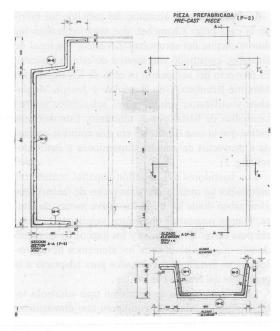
Detalle de los paneles de hormigón visto machihembrados en forma de artesa del pabellón de Nueva York (Proyecto original sin publicar)
